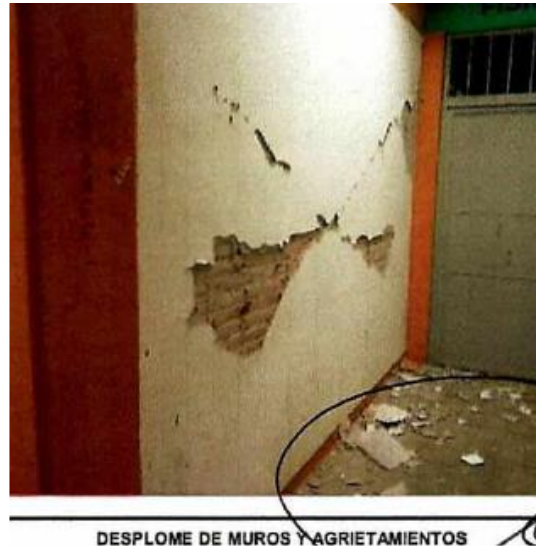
Falla por tensión diagonal en muros de mampostería.
